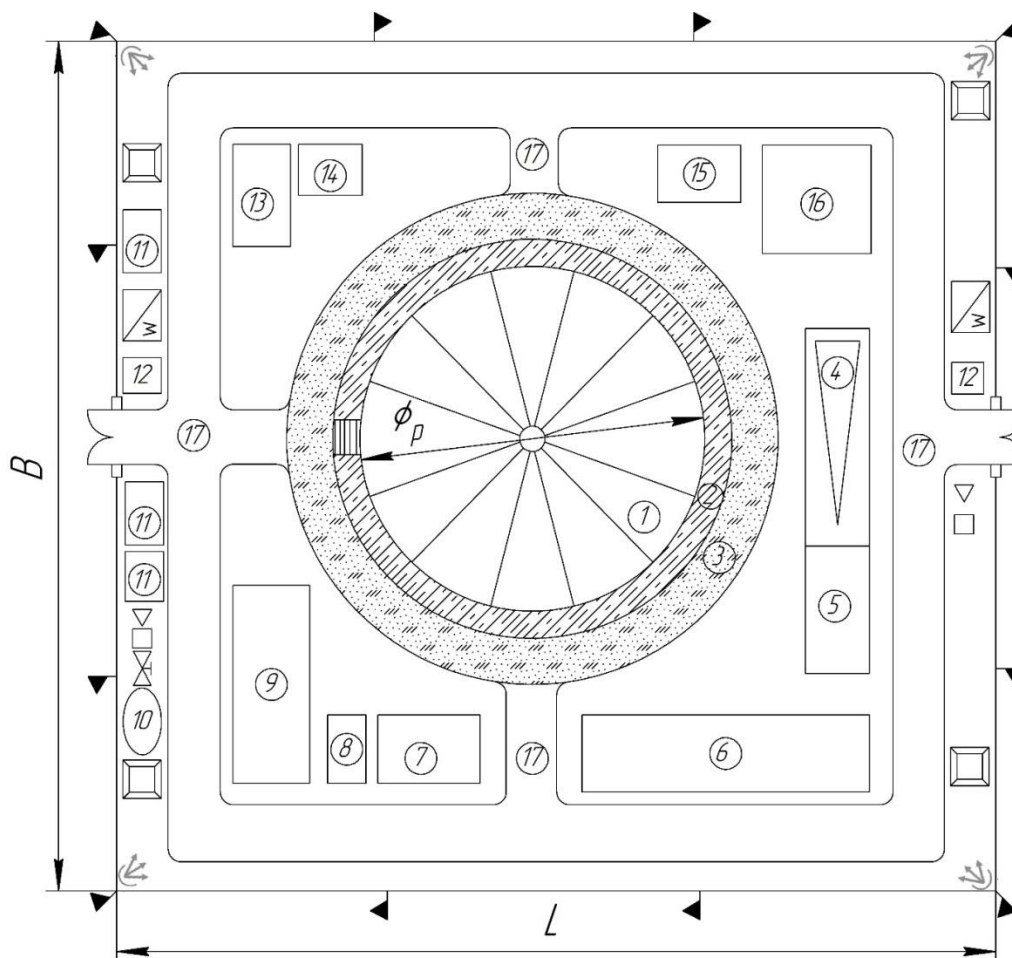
Планировка монтажной площадки сборки и сварки резервуара:
